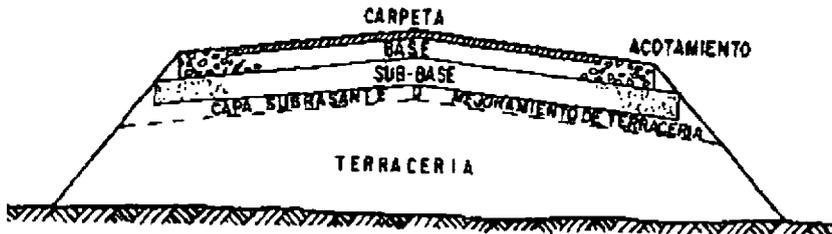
Corte típico de un pavimento flexible en terraplén.
